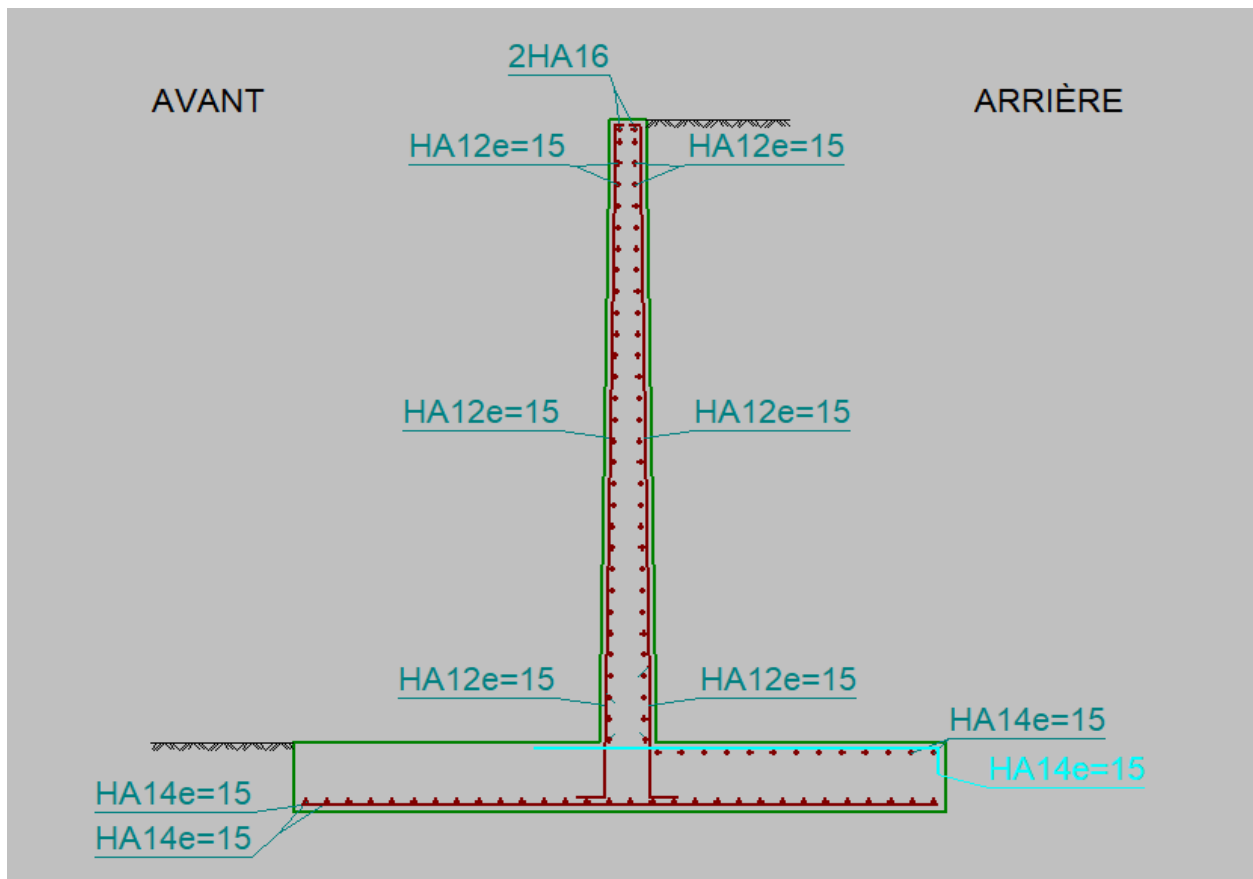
Le schéma d'armature d'un mur de soutènement
